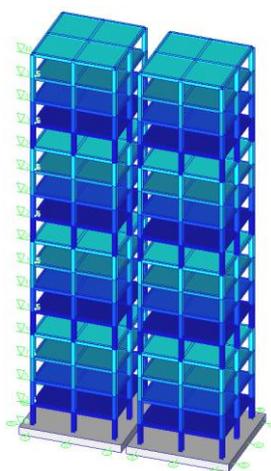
Вид двух рассматриваемых условных зданий на плитных фундаментах
